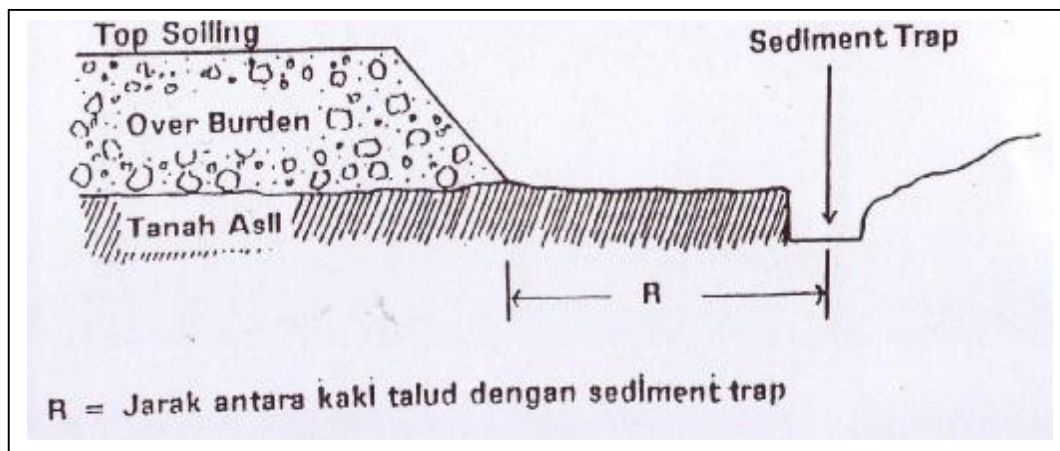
Pengambilan Tanah Pucuk di Mining Pit dan Cara Penambangan Tanah di atas Over Burden di Waste Dump
